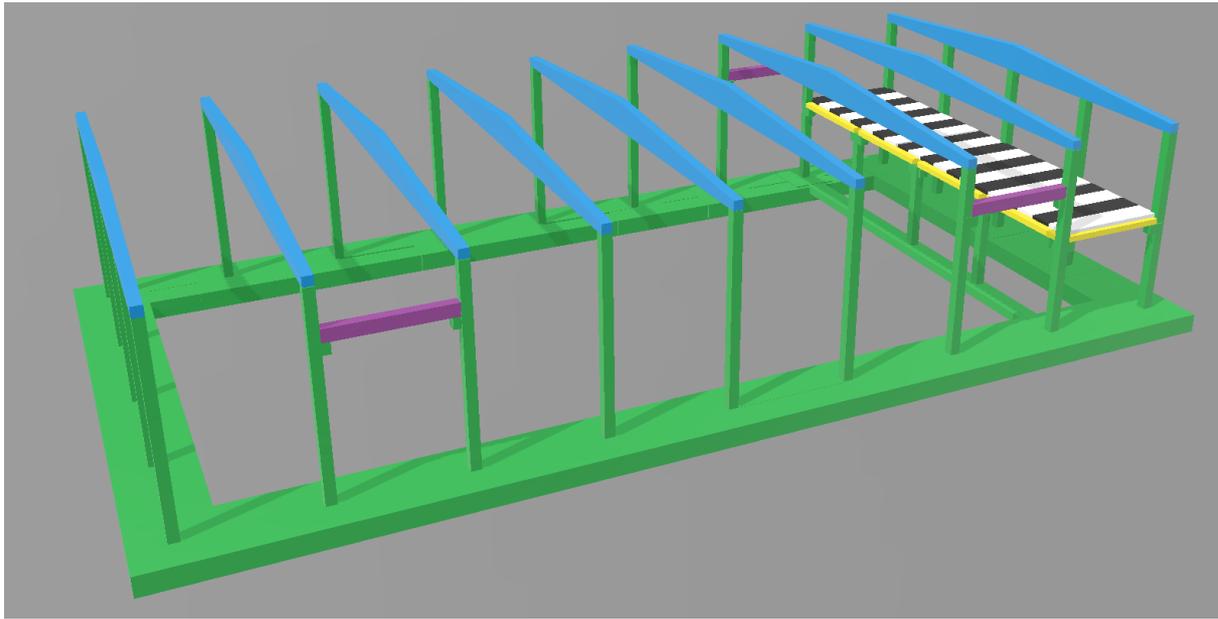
34 Paso 5: Colocación de las vigas Delta 2 Pretensadas [3D Builder, 2019]
